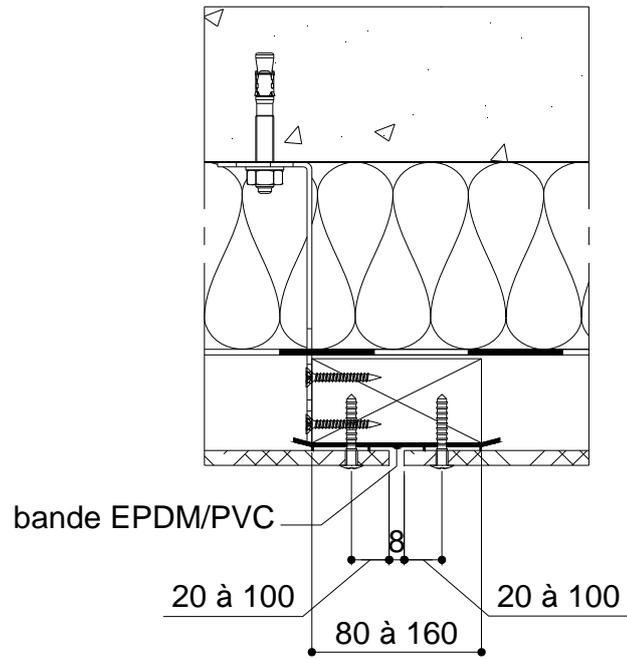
Joint vertical (coupe horizontale) sur ossature bois (cote en mm)
